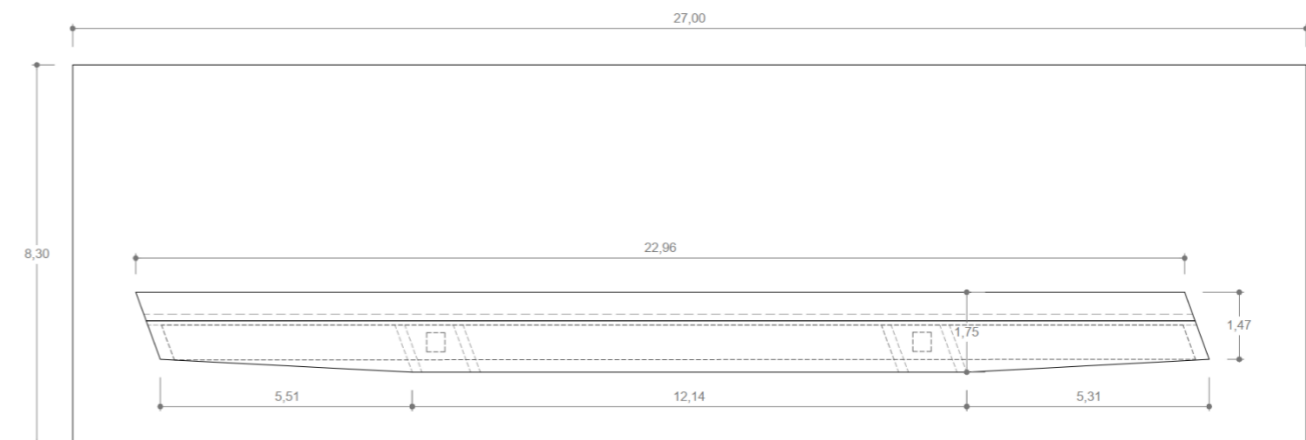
Vista en planta de las zapatas y estribos (fuente: elaboración propia)
